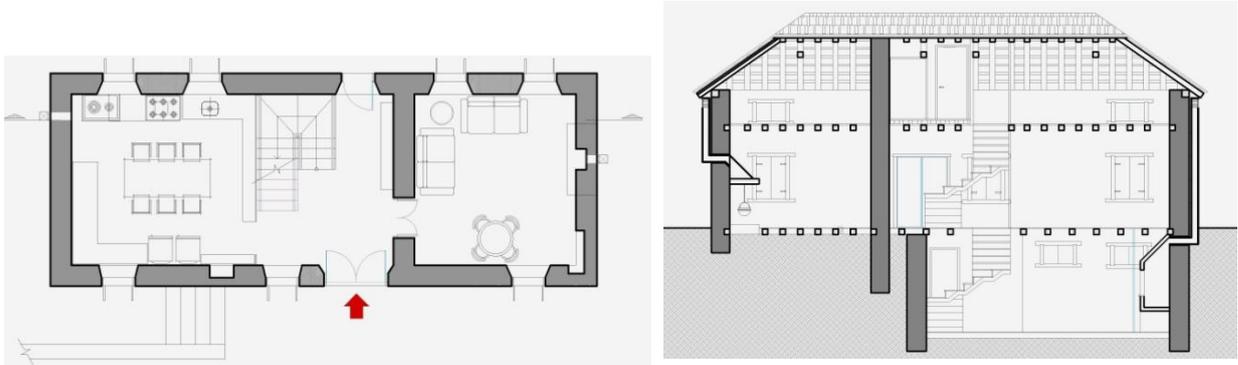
Planta Baixa Térreo e Corte Longitudinal Casa Barp. Fonte: Ultramar Arquitetos.
